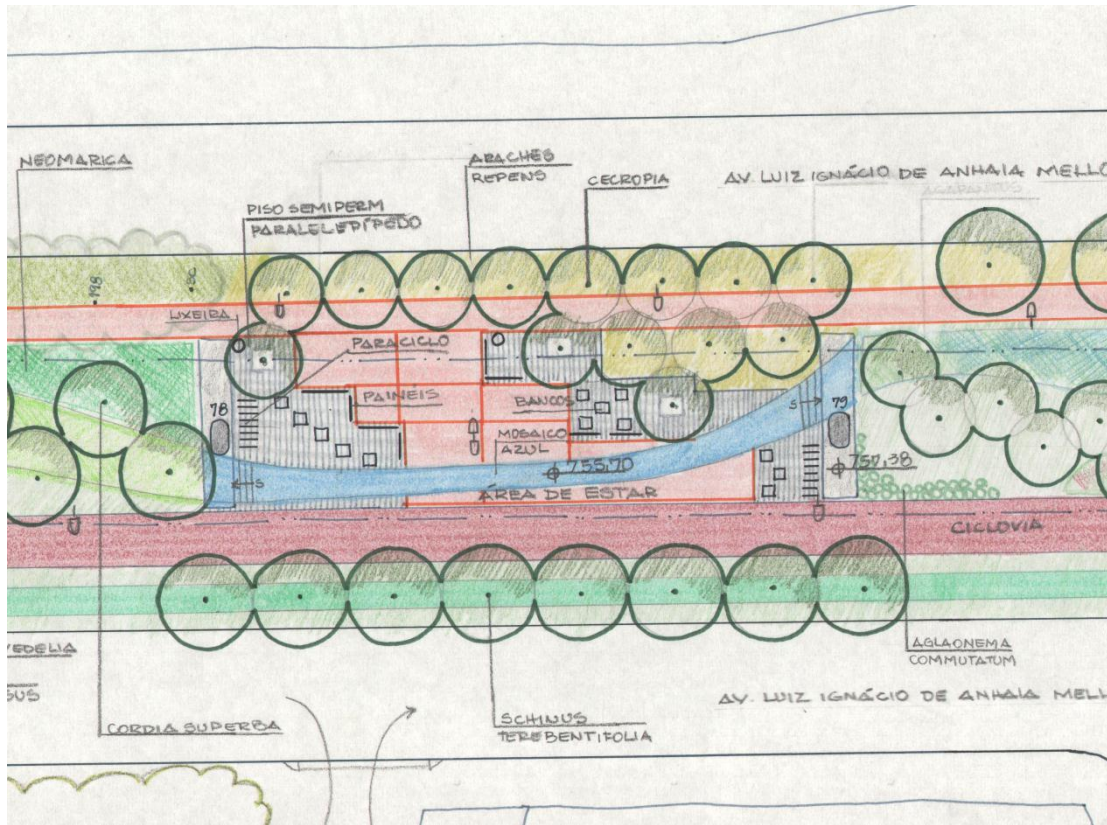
Proposta da Área com Painéis Informativos entre pilares 78/79
